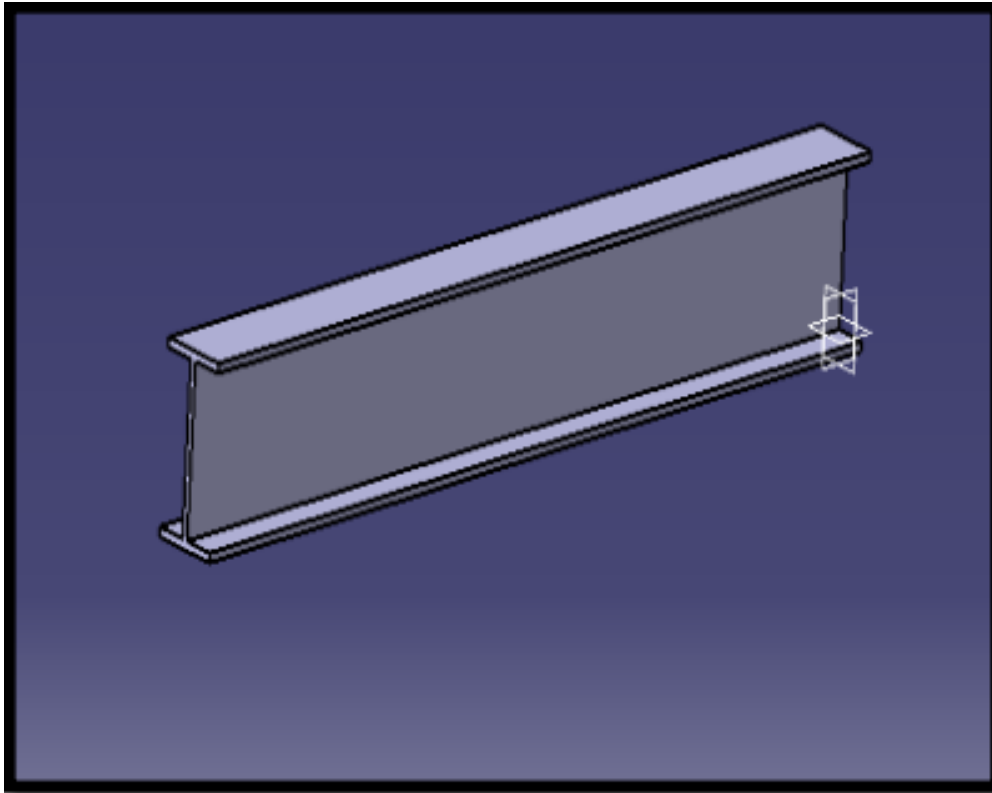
Modelagem tridimensional do perfil estrutural em seção "I" (I-Section)
